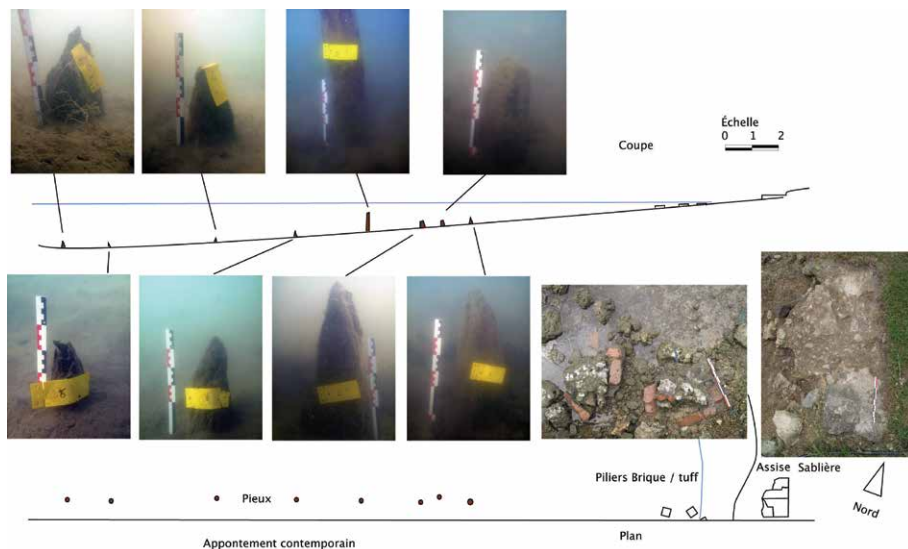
a Relevé et photographies des structures composant l'appontement sur pilotis du site de la Darse (Petit-Canal) (DAO / Clichés : JS Guibert).
